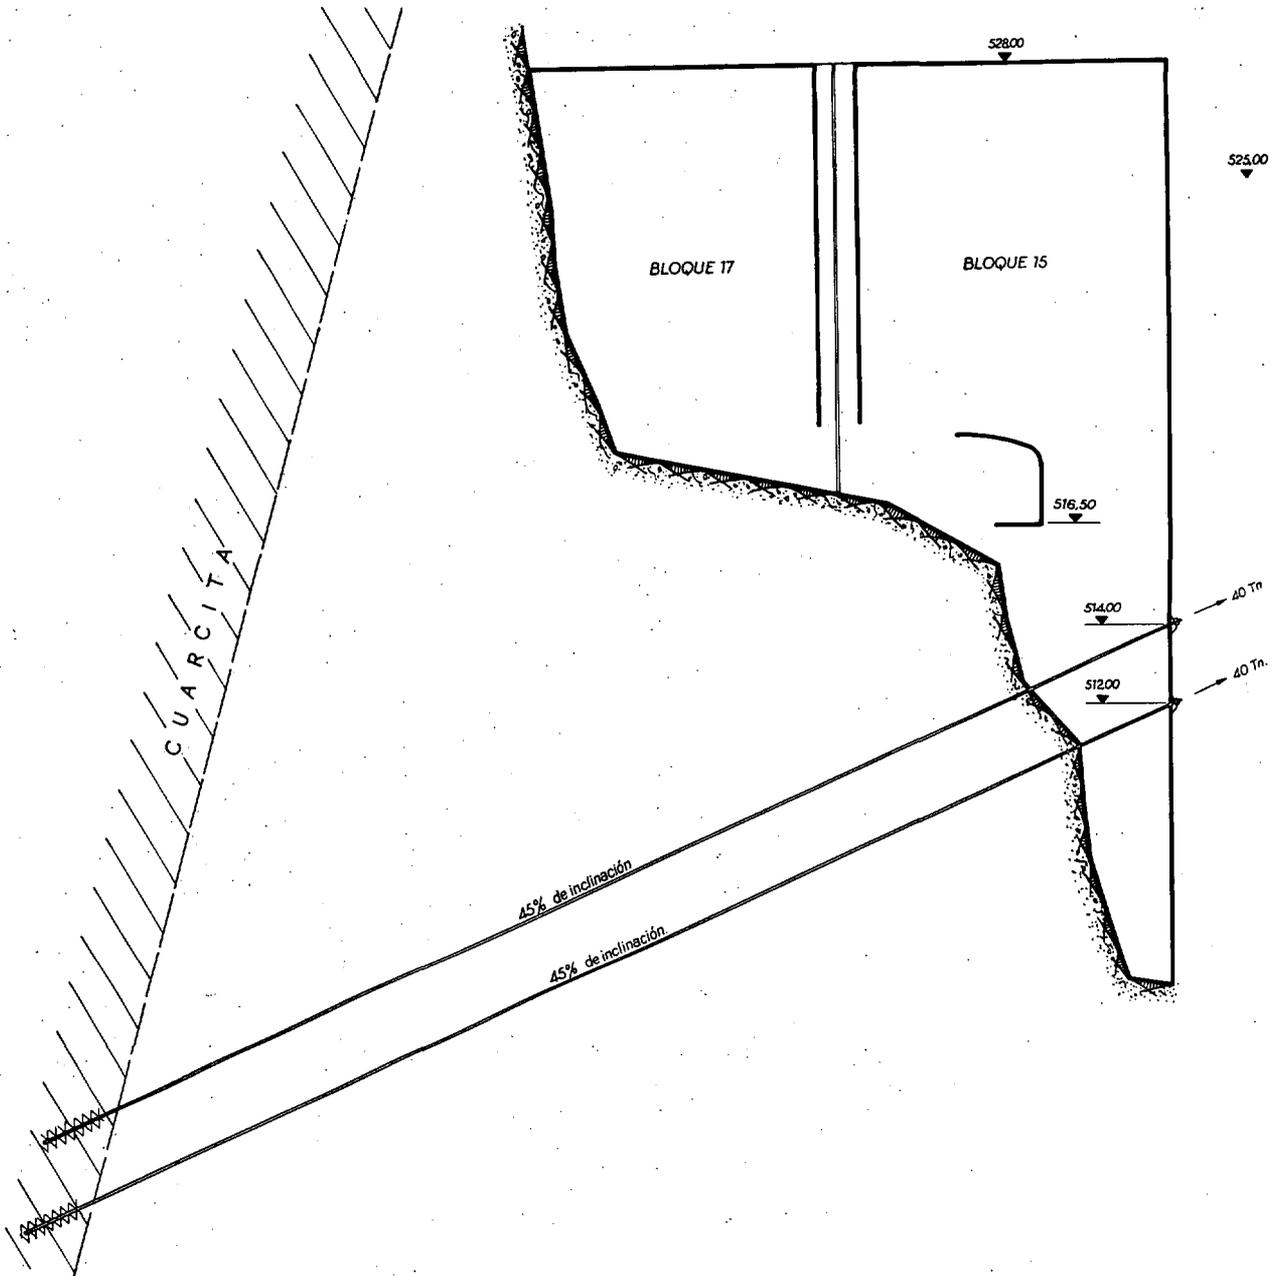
Presa de Santa Eulalia. Sección muro en ala del estribo derecho.
